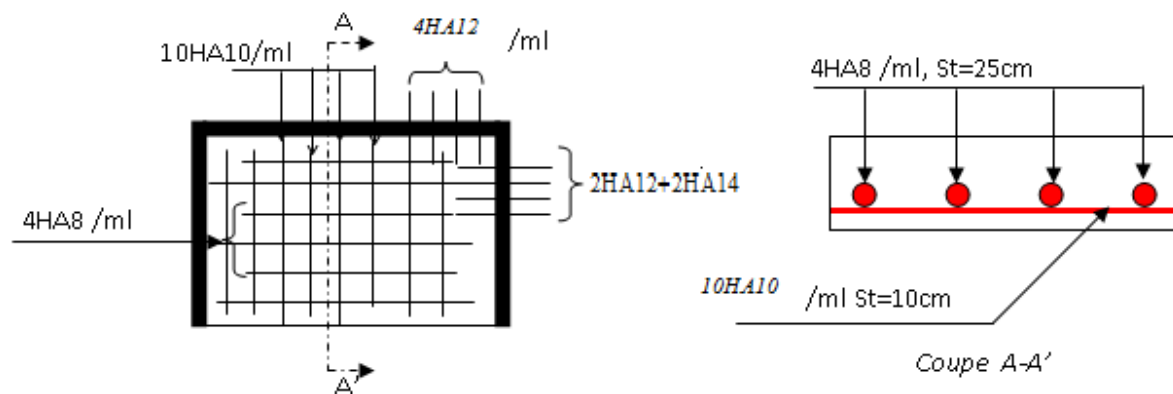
schéma ferrailage du balcon sur trois appuis
